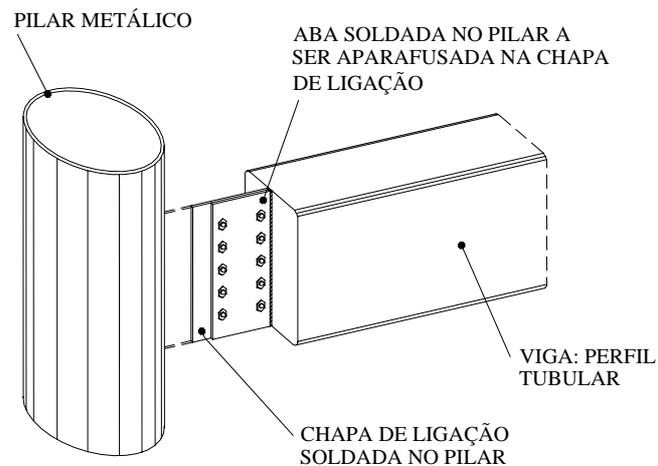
Detalhe da ligação entre o pilar tubular de seção circular e a viga tubular de seção retangular.
